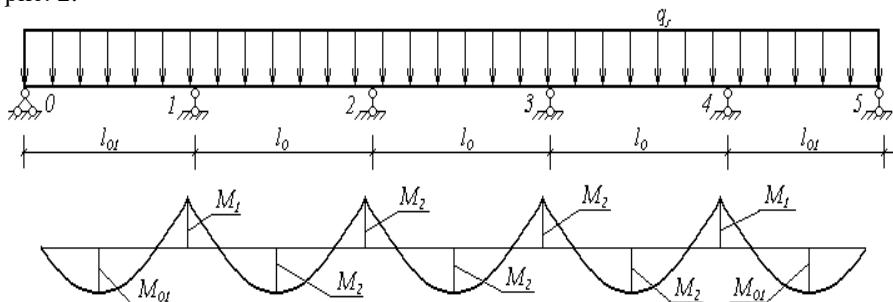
Розрахункова схема плити та епюра згинаючих моментів
